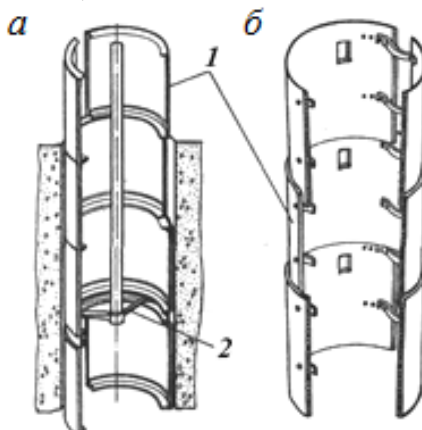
Кольцевая крепь: *а* – металлическая; *б* – стеклопластиковая; 1 – кольцо; 2 – спуско-подъемное устройство для монтажа и демонтажа крепи
